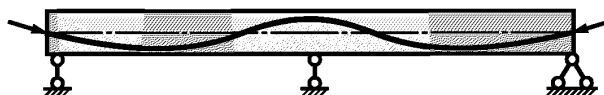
Схема раскладки напрягаемой арматуры по высоте сечения неразрезной конструкции
